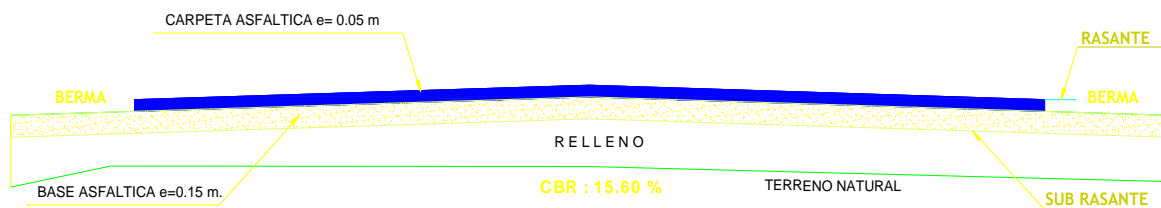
Estructura del pavimento Alternativo N°1 (ver anexo F-2).
